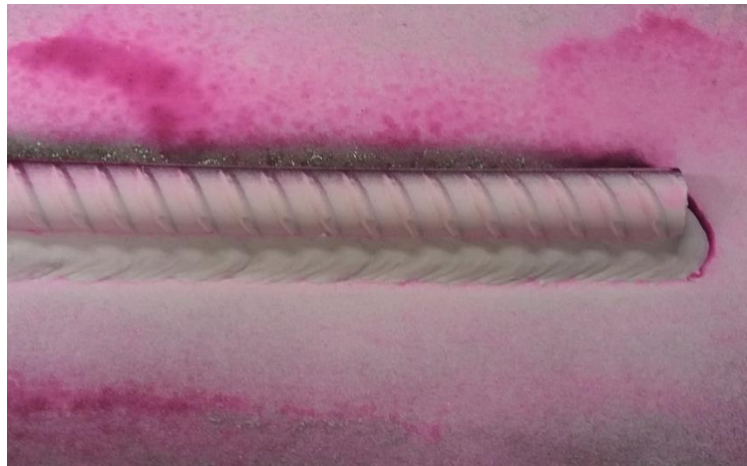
Ensaio não destrutivo de soldadura através de líquidos penetrantes (arquivo pessoal)
